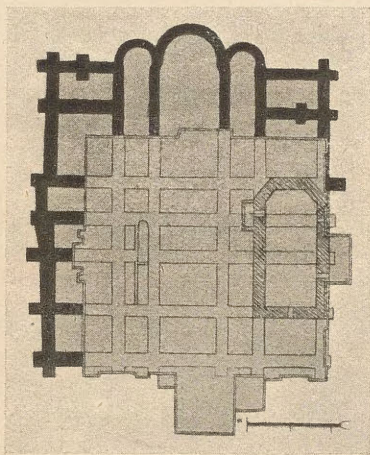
Grundriß der „Dessjatinnaja“-Kirche in Kiew.
